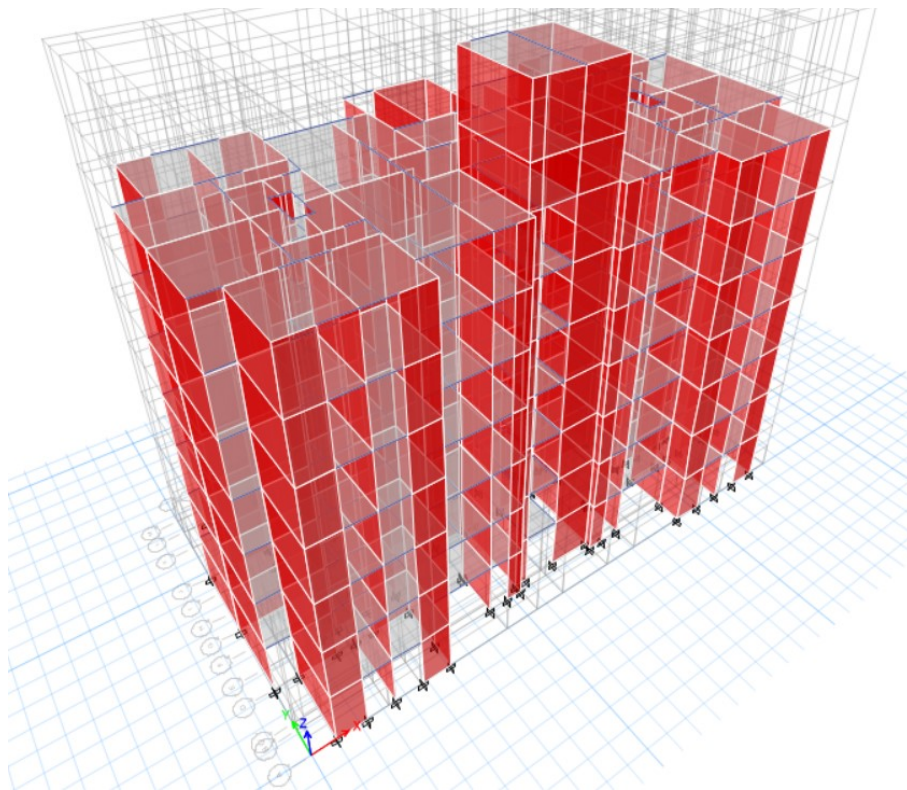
Disposición de elementos estructurales (Vista 3D) Sistema MDL - Edificio Blesser. Fuente: Elaboración Propia.
